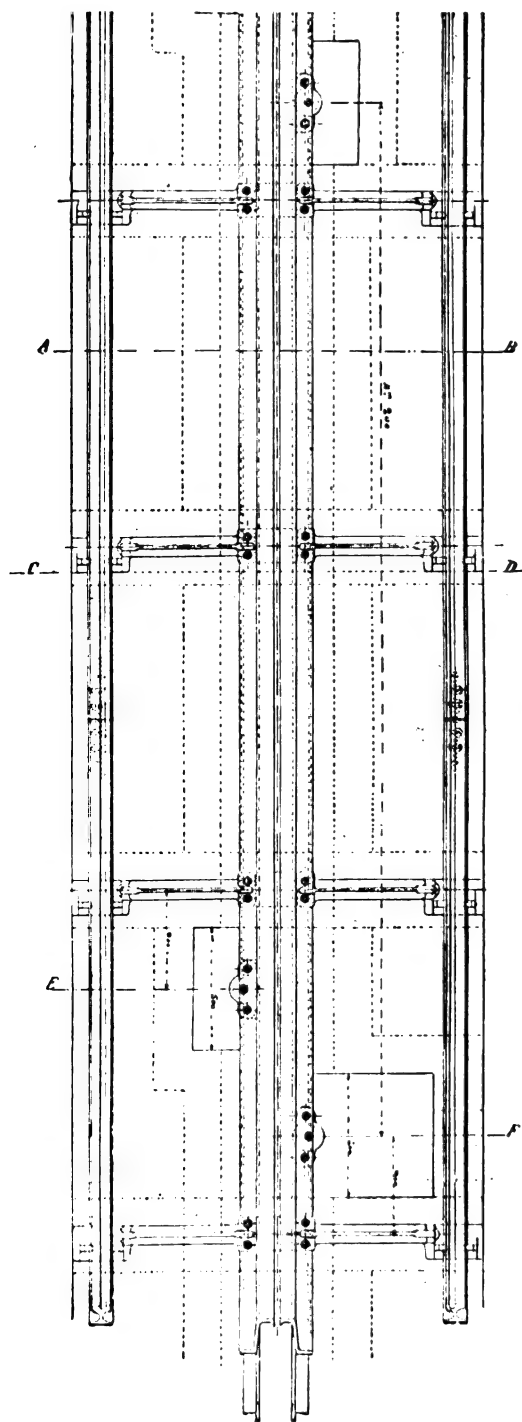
Vue en plan, le pavage enlevé, d'une voie avec caniveau central.
